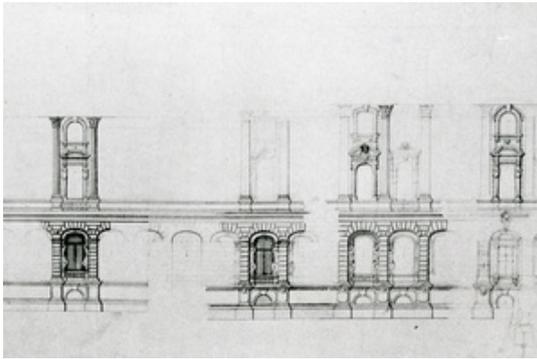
Skizze 19, Fassadendetail zu 18
